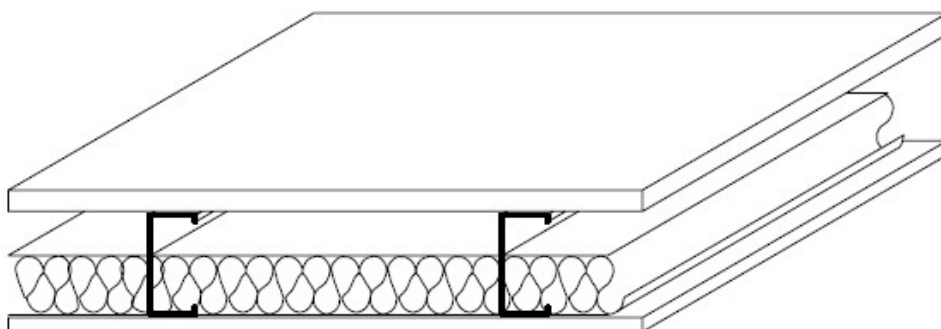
Pavimento em LSF (PLSF1) (SCI, 2003)
